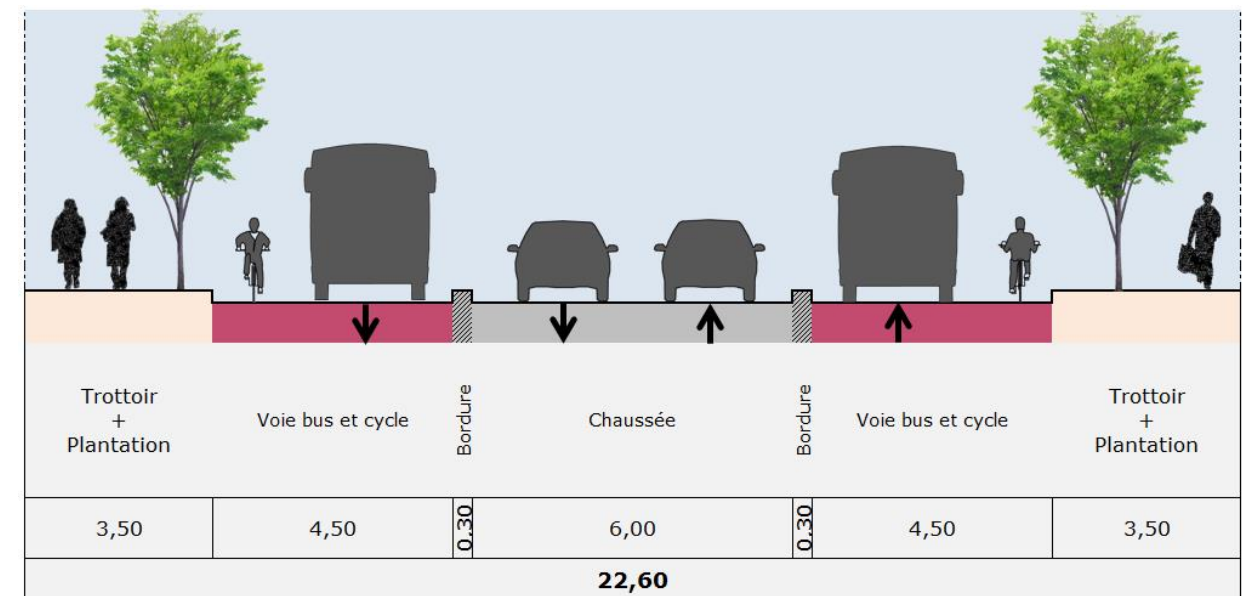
Coupe type pour l'insertion d'un site propre bilatéral
